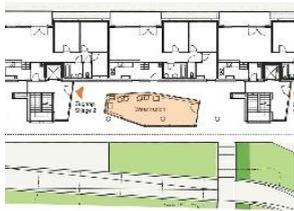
Waschsalon im Erdgeschoss, Bauteil B
